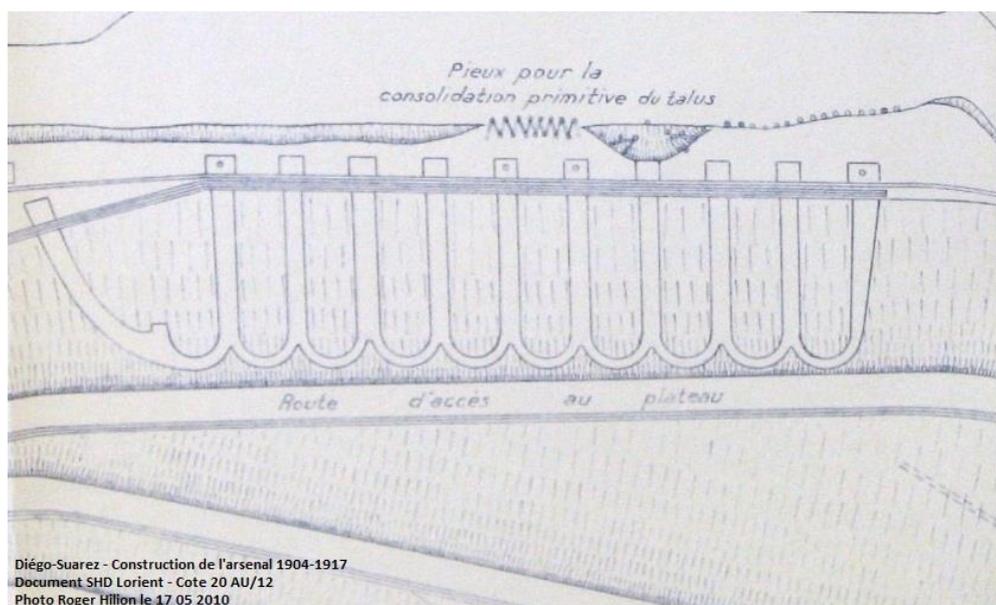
Arcades de soutènement de la route (Extrait de plan – Archives SHD Lorient)
